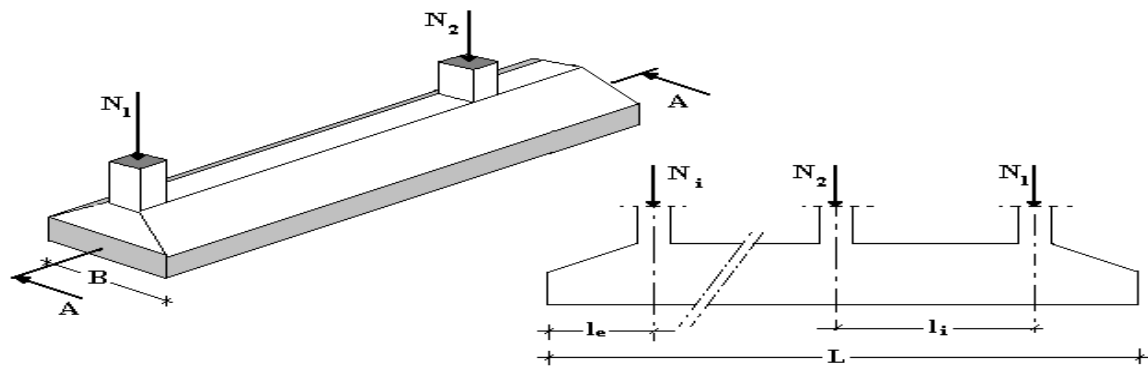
La forme de la semelle filante Coupe A-A.
